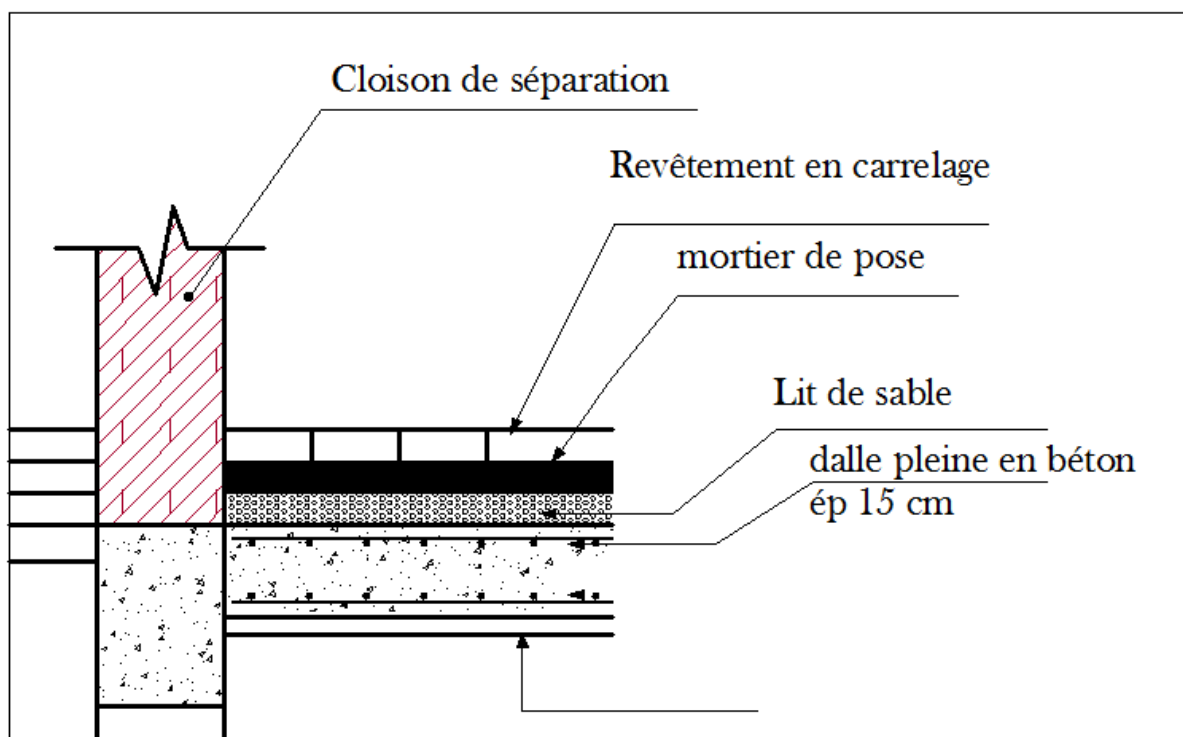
Détail Plancher Niveau sous -sol -1 et 2
